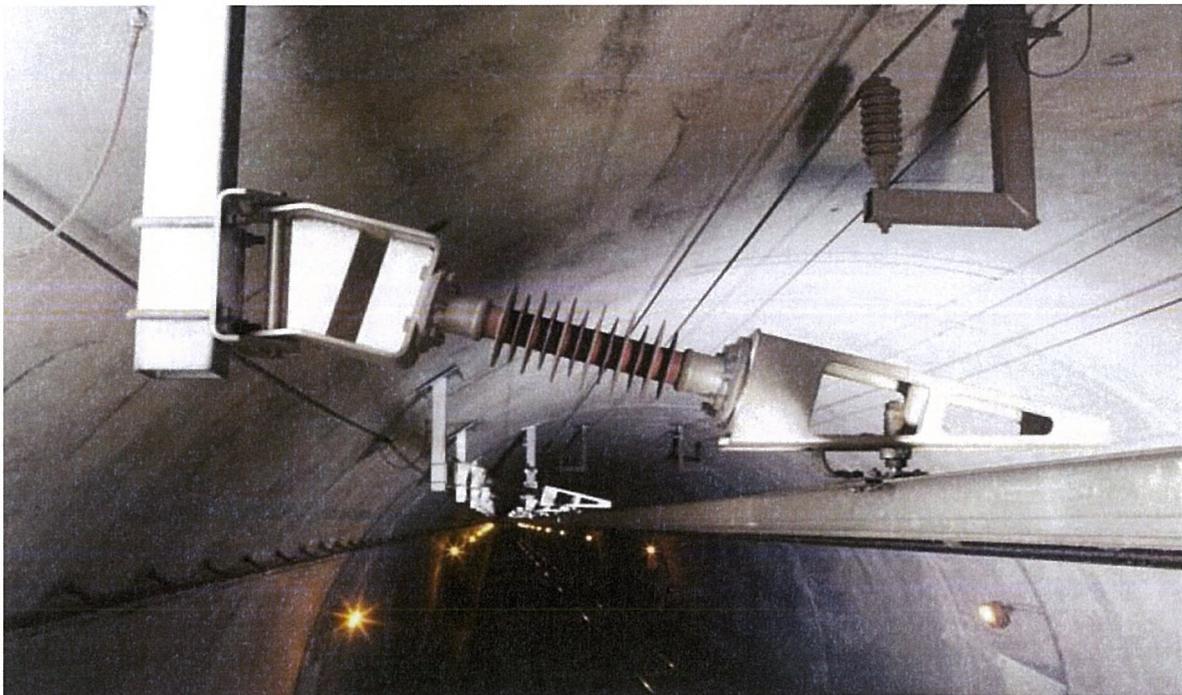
Tunnelquerschnitt mit beispielhafter Darstellung der Oberleitung im Tunnel
